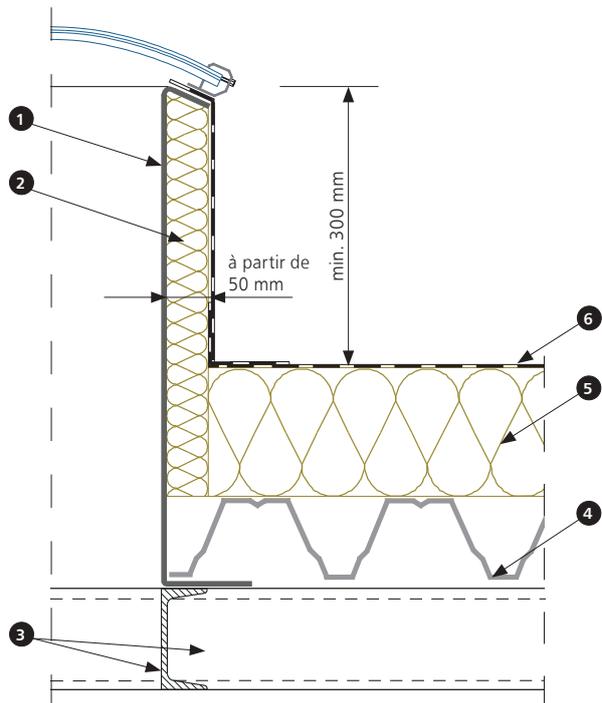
Vue de haut d'un lanterneau coupole mcr PROLIGHT
